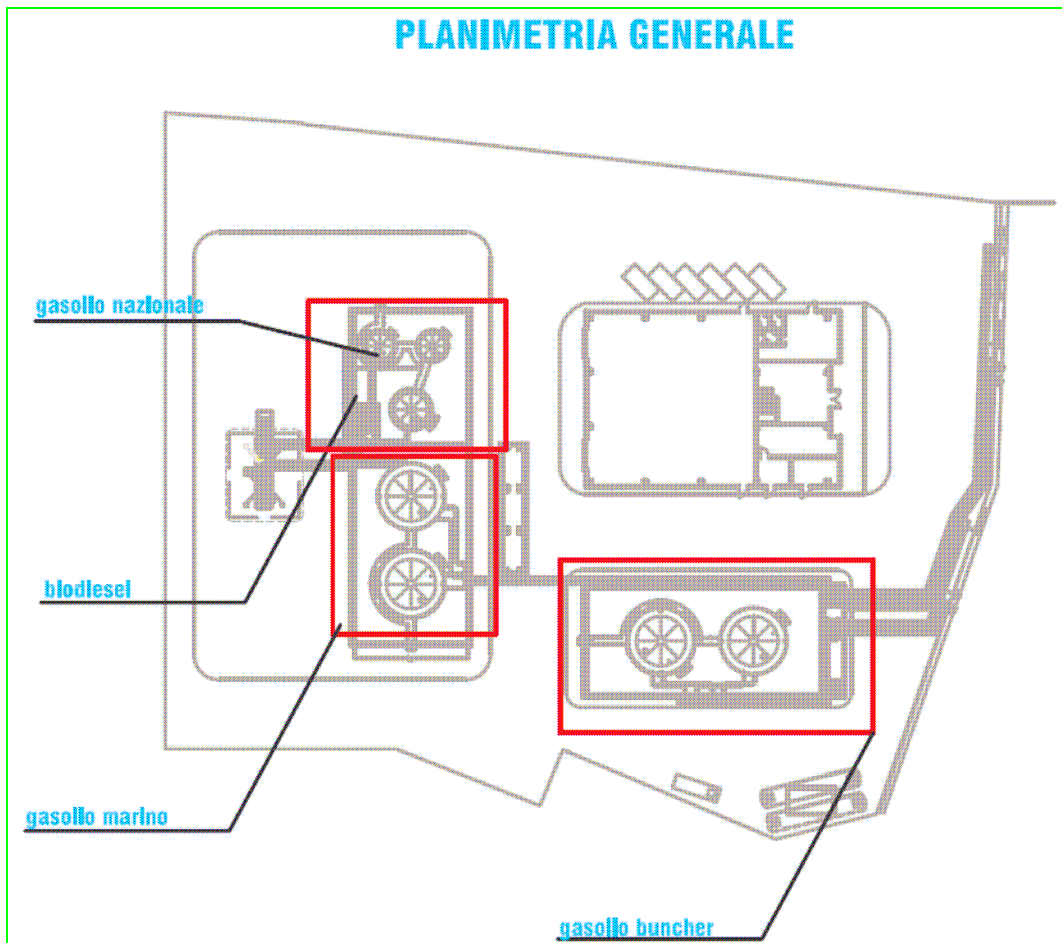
Planimetria generale di progetto (per i dettagli si rimanda al progetto).
